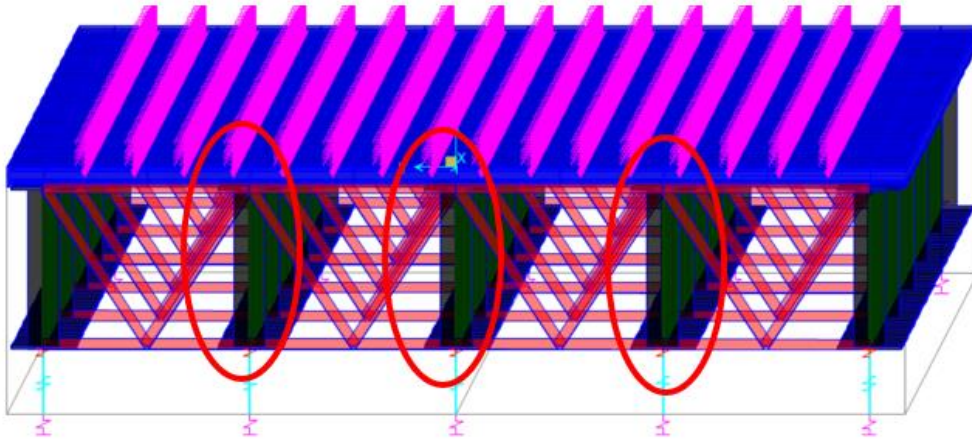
Ubicación de las vigas internas en el modelo. Elaboración propia
